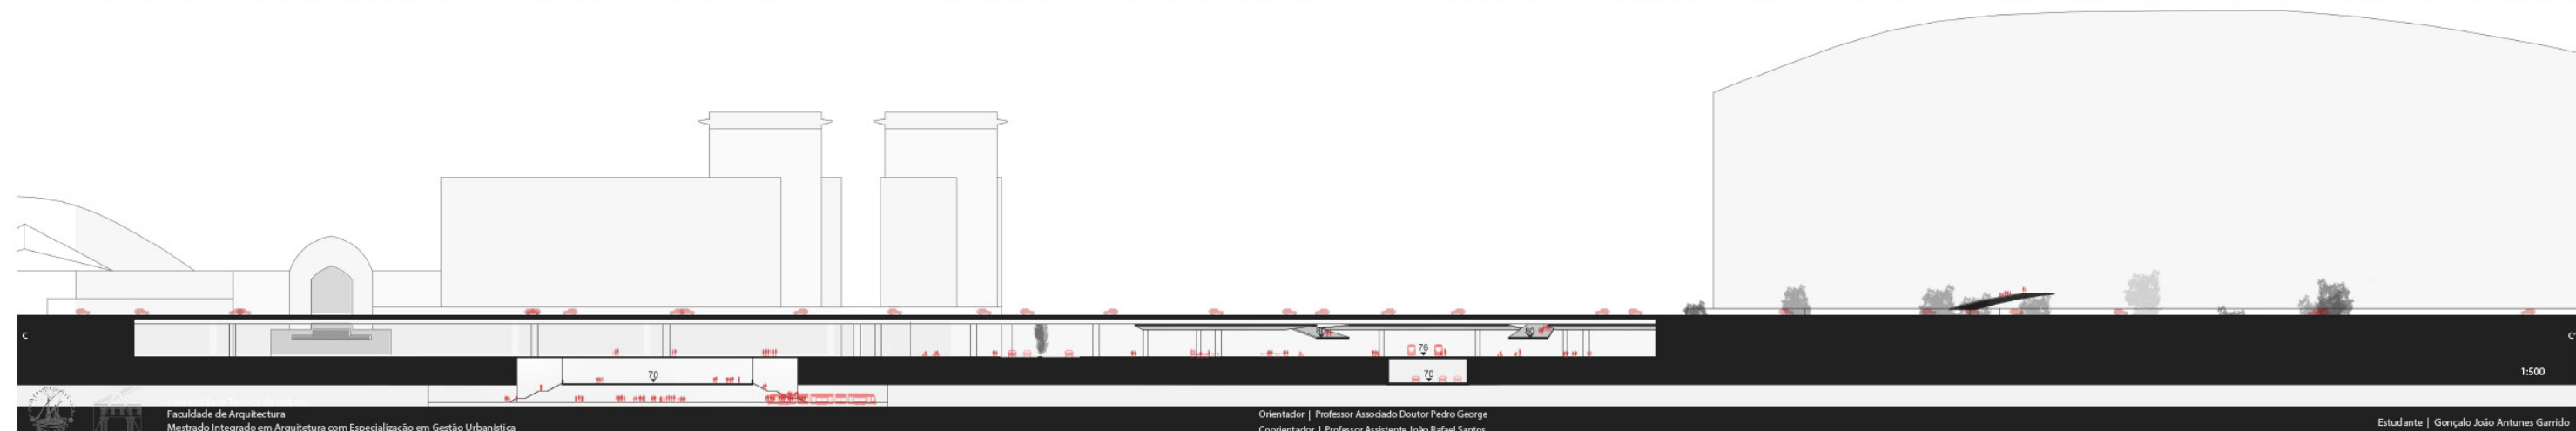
Painel 10, Projeto Urbano, Planta do interface (Fonte: Autor)
